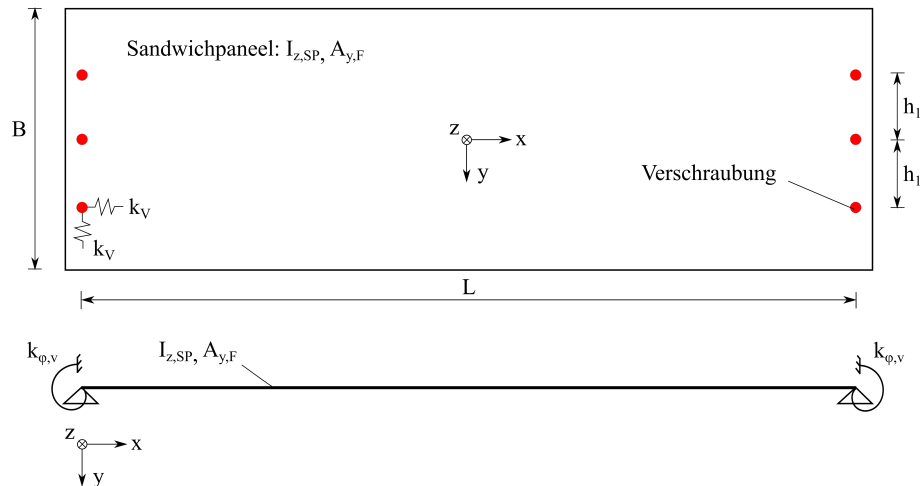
Sandwichpaneel bei Belastung in Fassadenebene mit statischem Ersatzsystem
